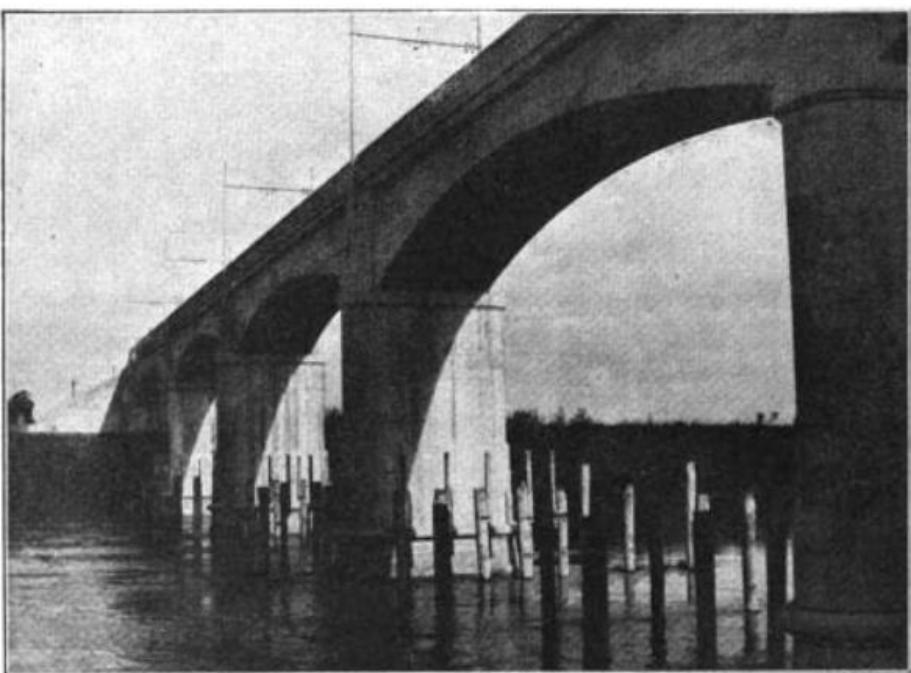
Ponte sul Tevere. Vista della sottostruttura delle travate.
